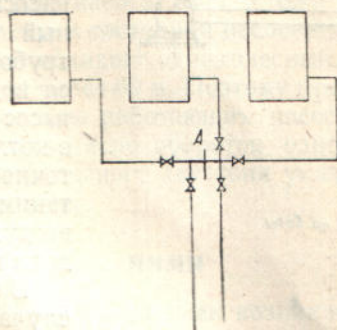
Схема с одним всасывающим водоводом для трех насосов.
